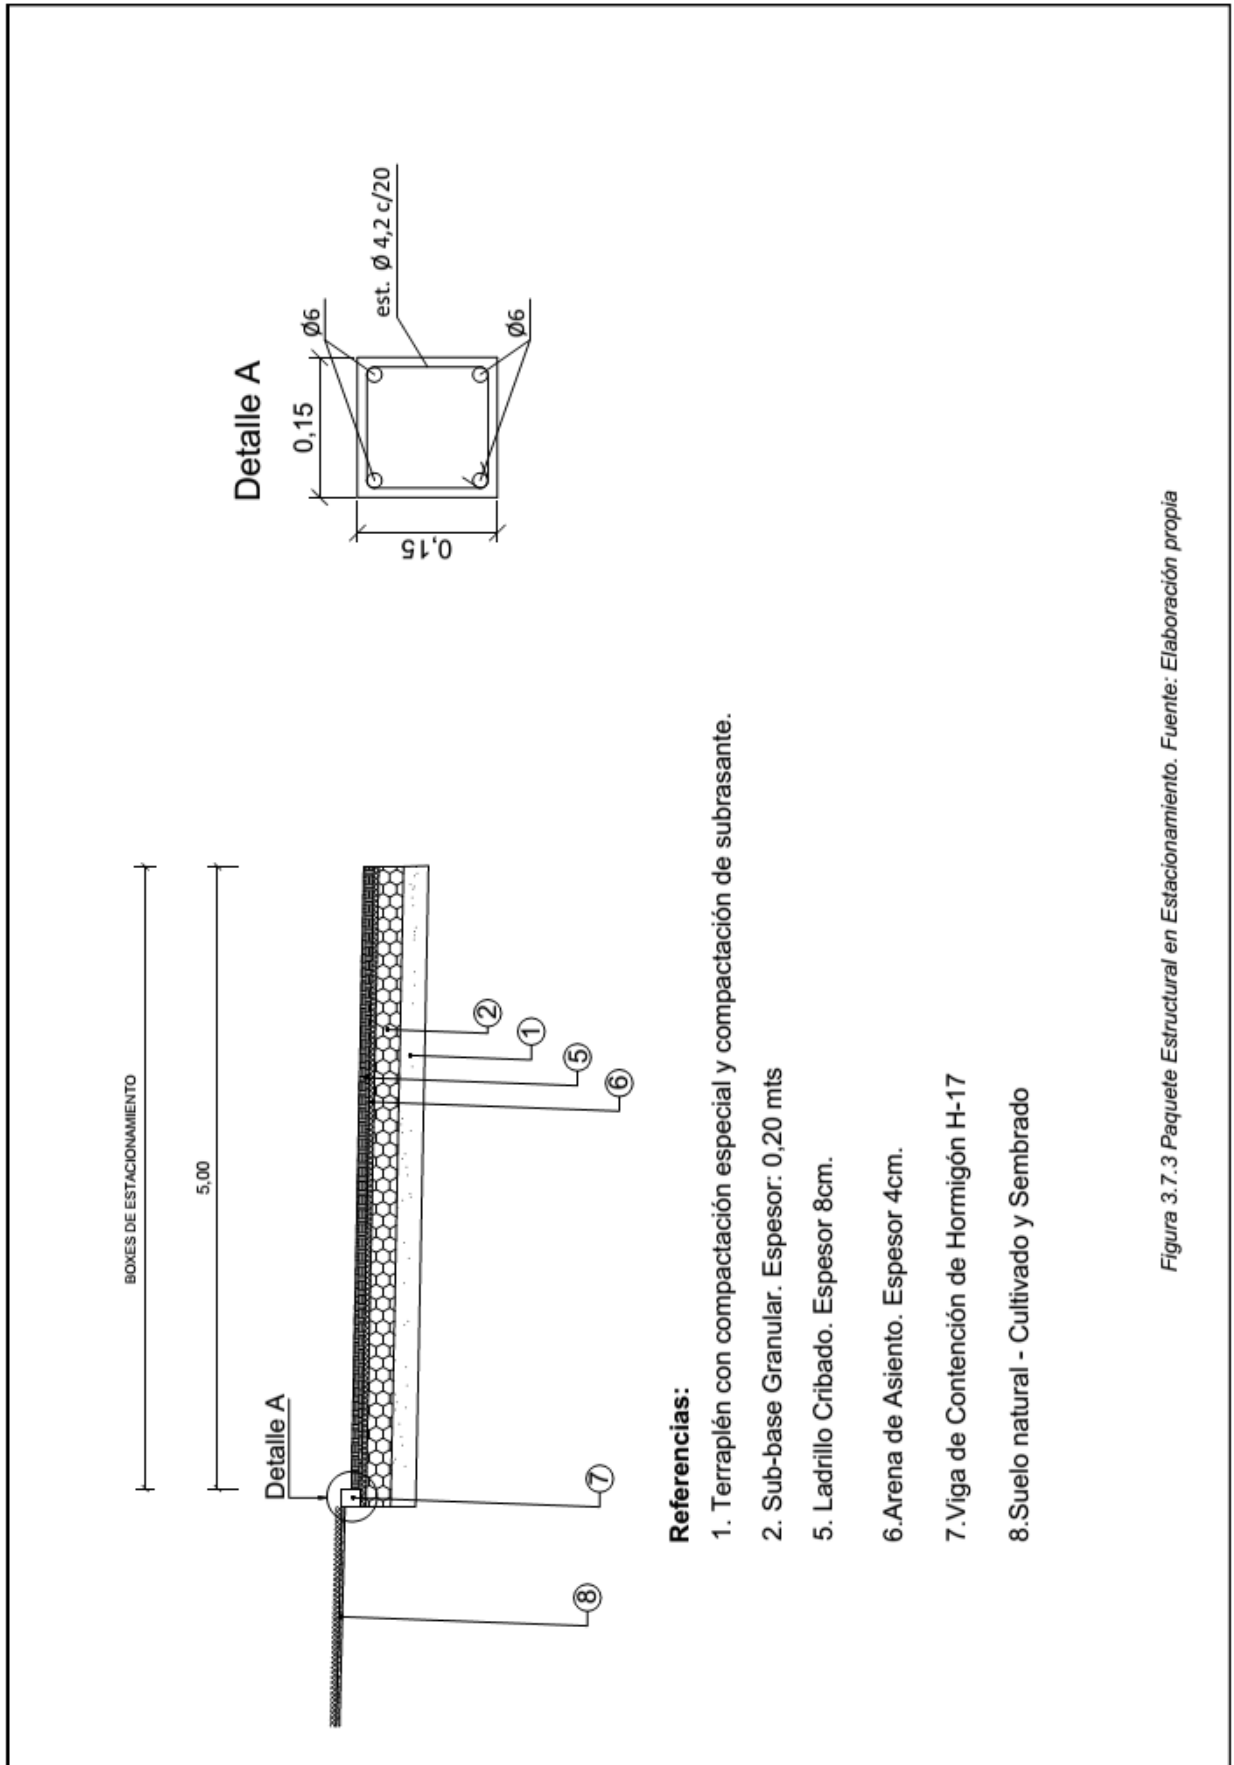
Paquete Estructural en Estacionamiento. Fuente: Elaboración propia
